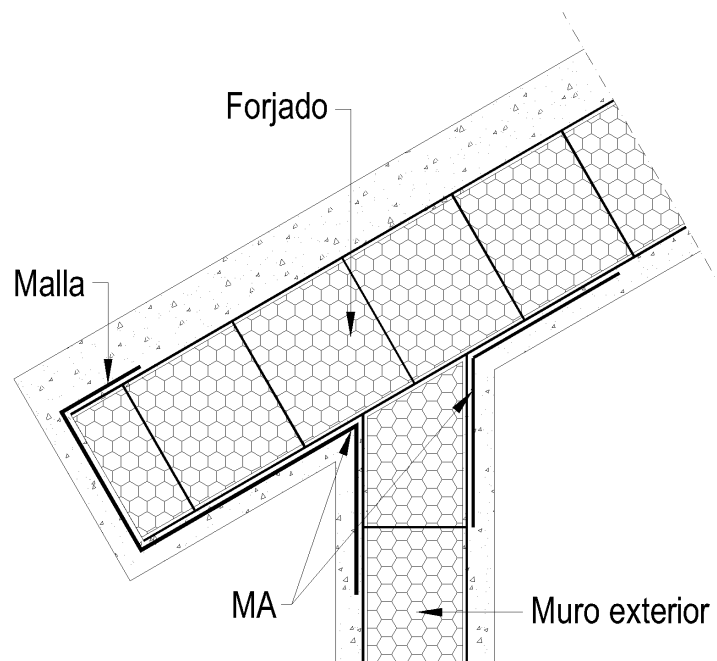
2. Detalle de la conexión muro-techo por medio de mallazos MA (sección vertical)
